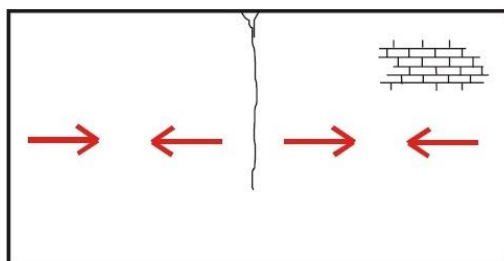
Fissura vertical em paredes por retração da alvenaria (DUARTE, 1998)
